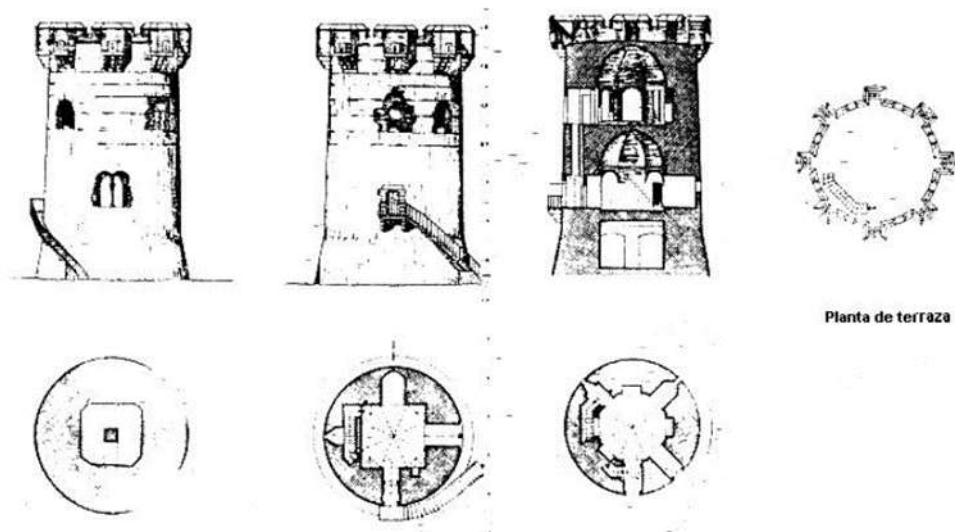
Secciones de las plantas de la torre. Fuente: www.cvc.gva.es
